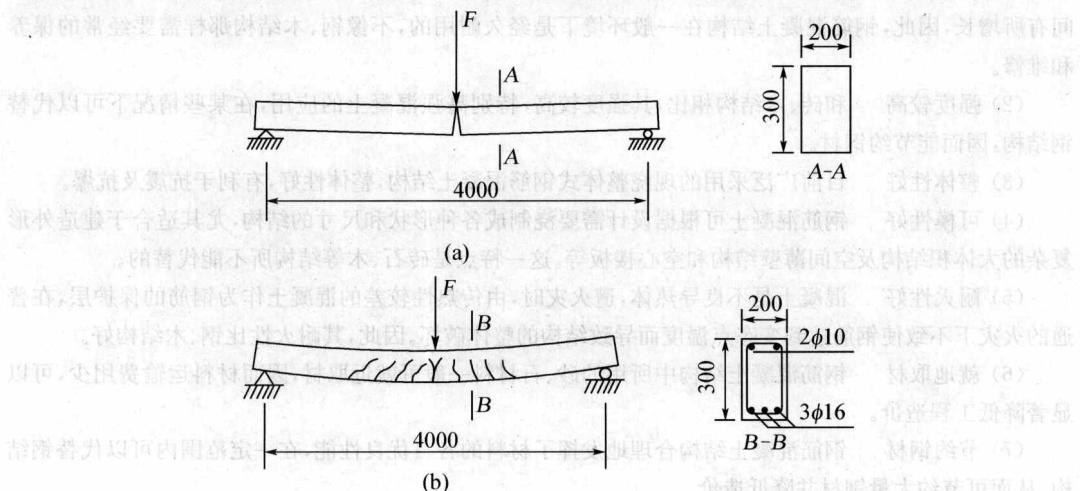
素混凝土及钢筋混凝土简支梁的承载力
